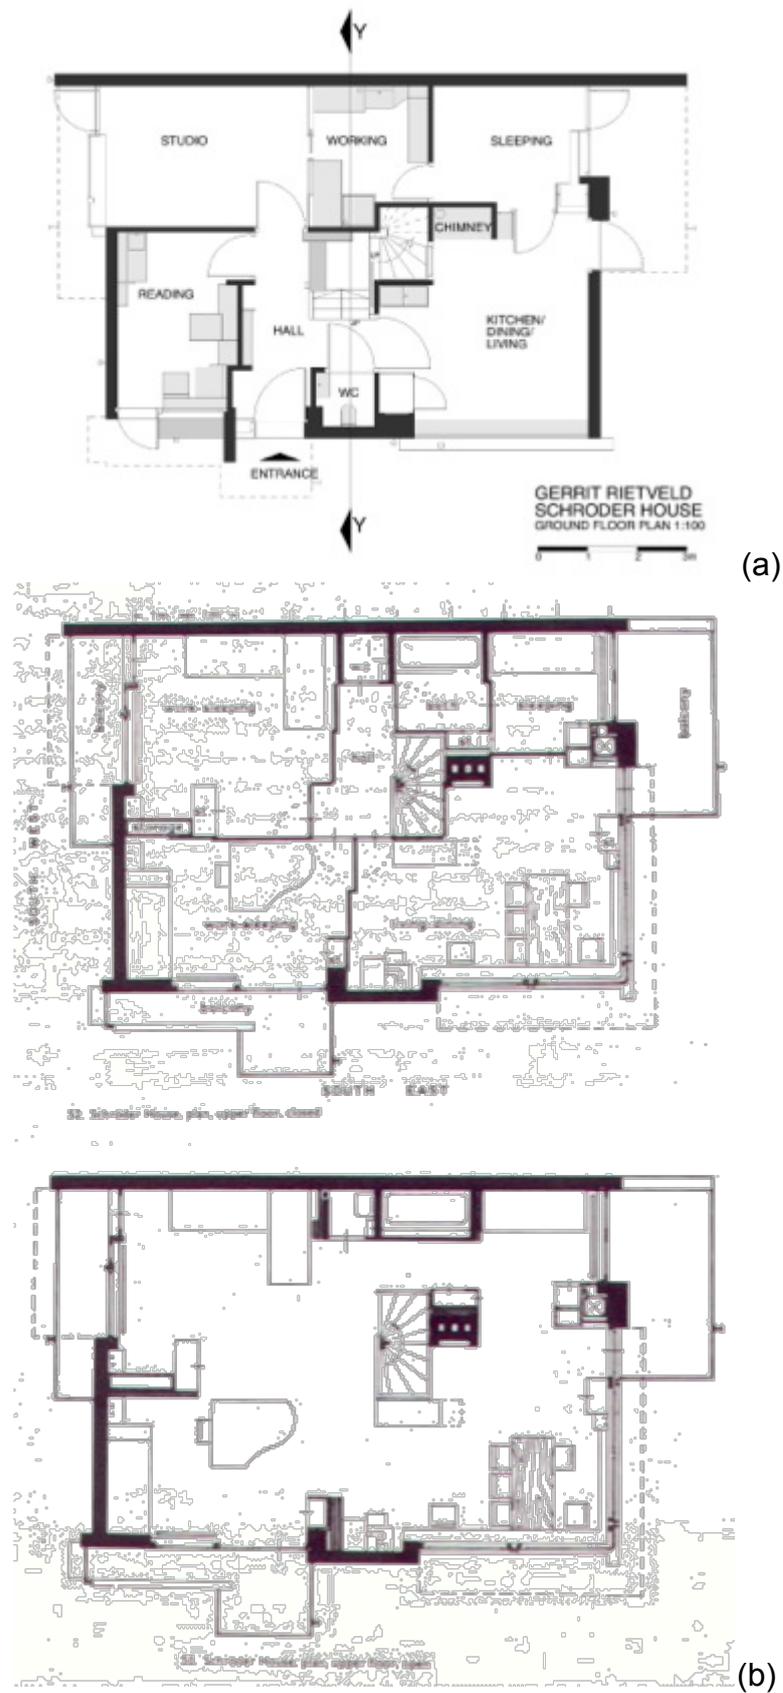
Planta do pavimento térreo (a) e Superior (b) da casa Schröder.
